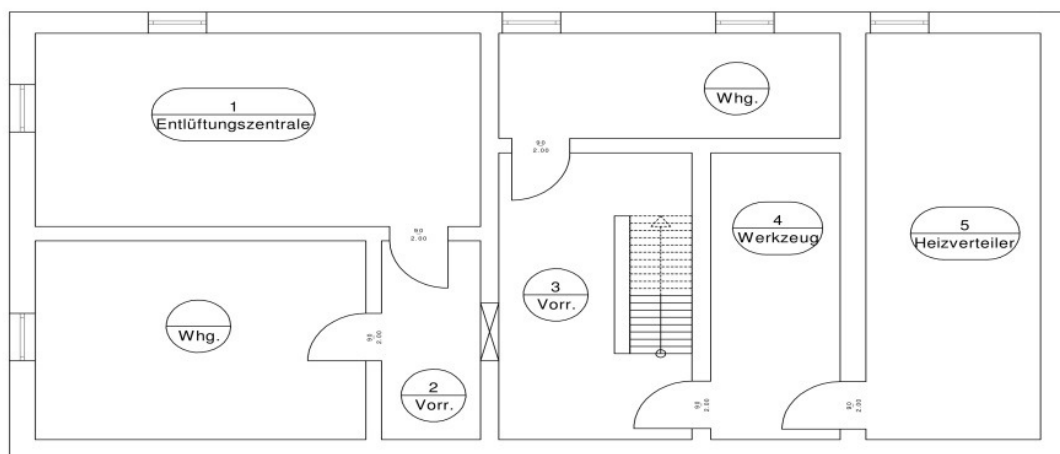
Grundriss Kellergeschoss FF Langenwang<sup>5</sup>
